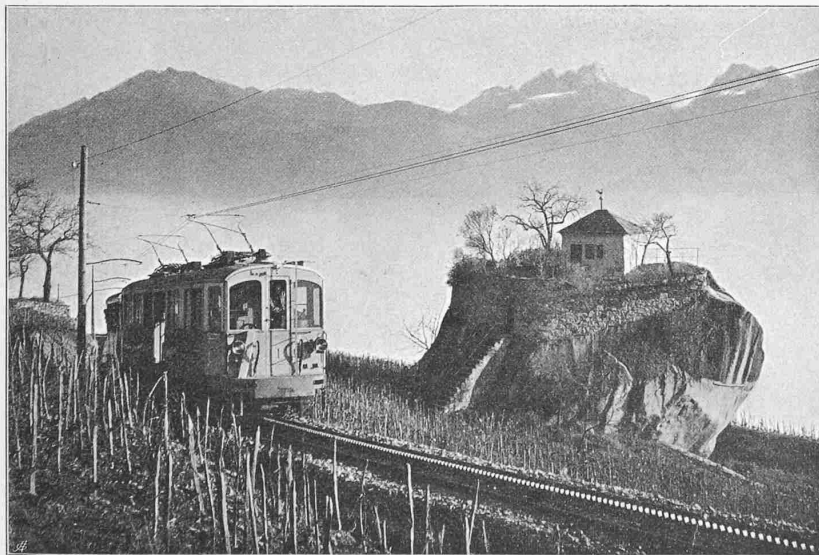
Erste Zahnstangenrampe bei der «Pierre des Marmettes».
